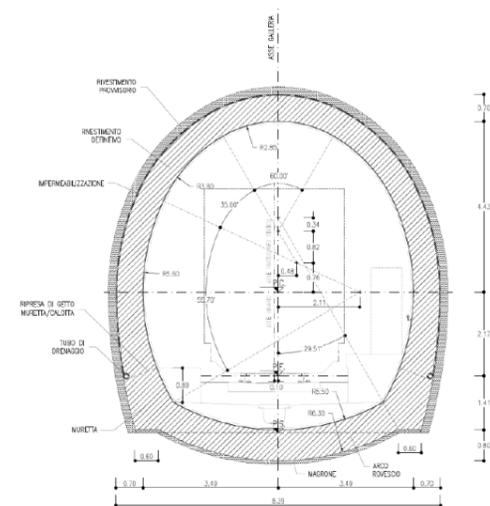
Sezione di intradosso galleria di linea a singolo binario per scavo tradizionale
